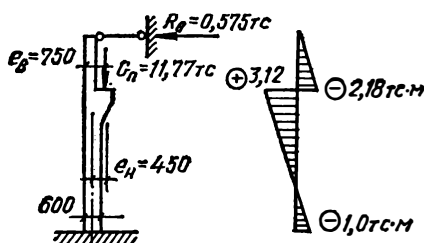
Расчетная схема и эпюра M от веса подкрановых балок и путей.
